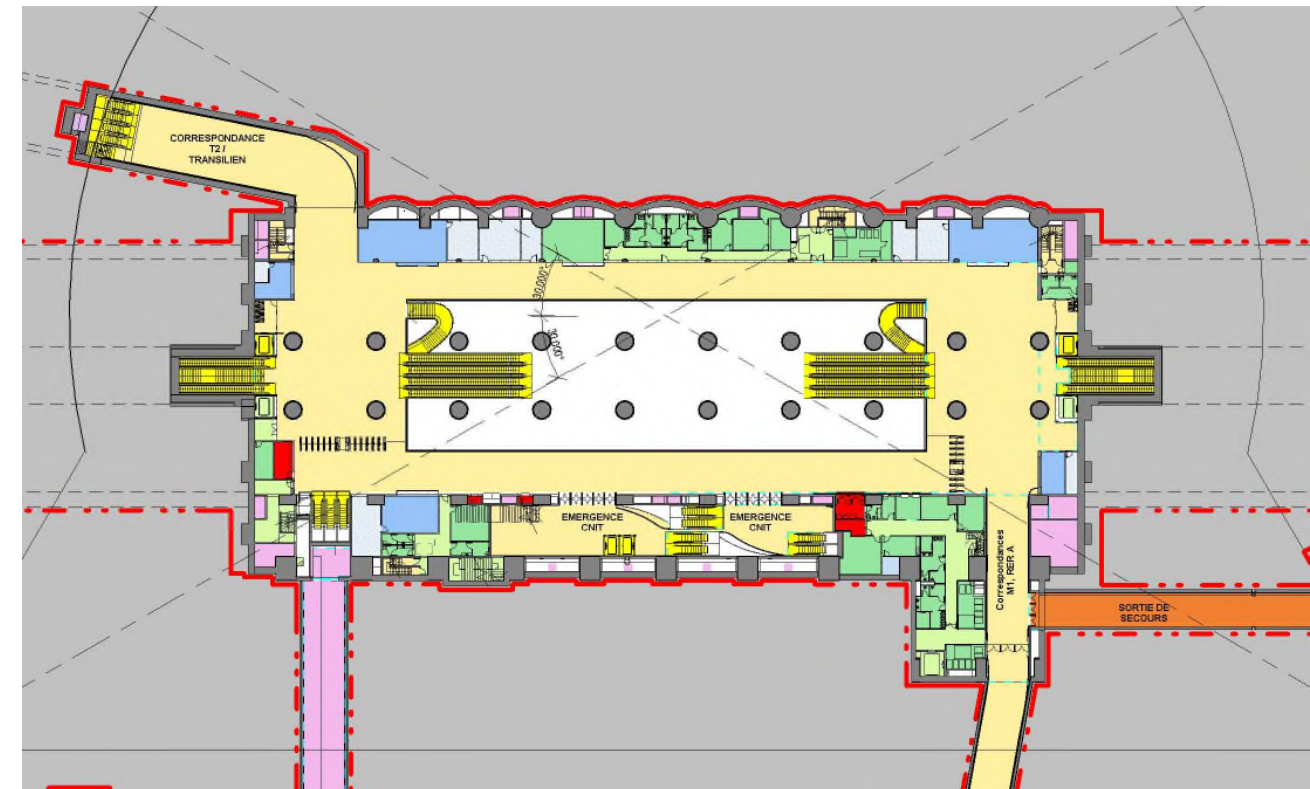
Vue en plan du niveau mezzanine (Source : SED)
